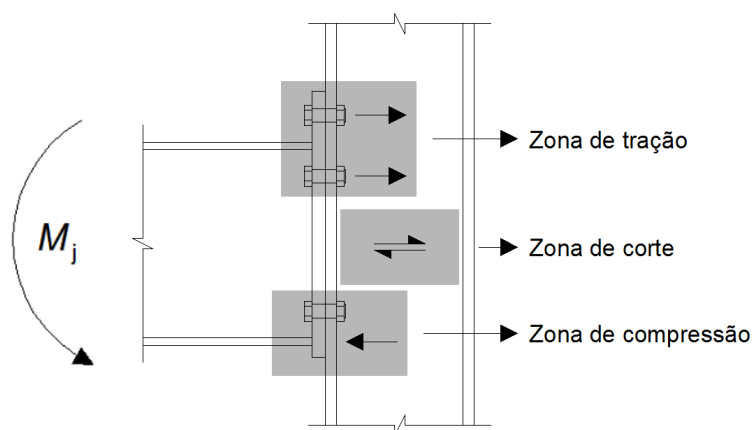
Zonas críticas de uma ligação viga-pilar.
